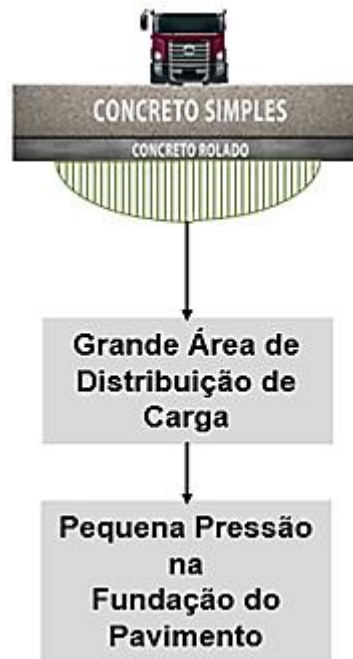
Esquema da distribuição de cargas no pavimento rígido.
